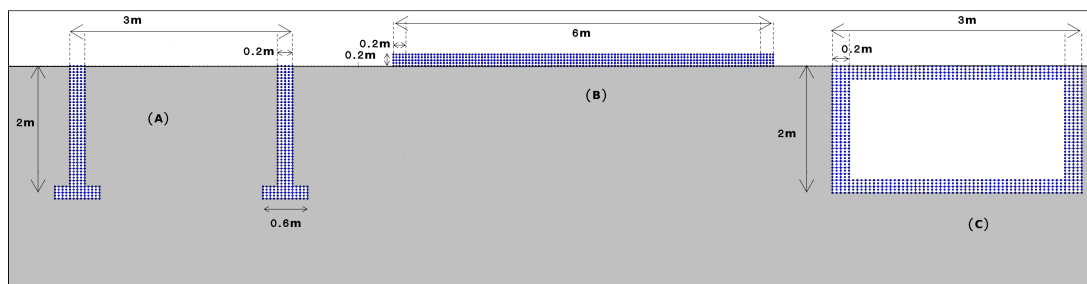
Schéma des trois types de fondations choisies dans cette étude, (A) : fondations sur semelles, (B) : radier en surface, (C) : caisson enterré.
